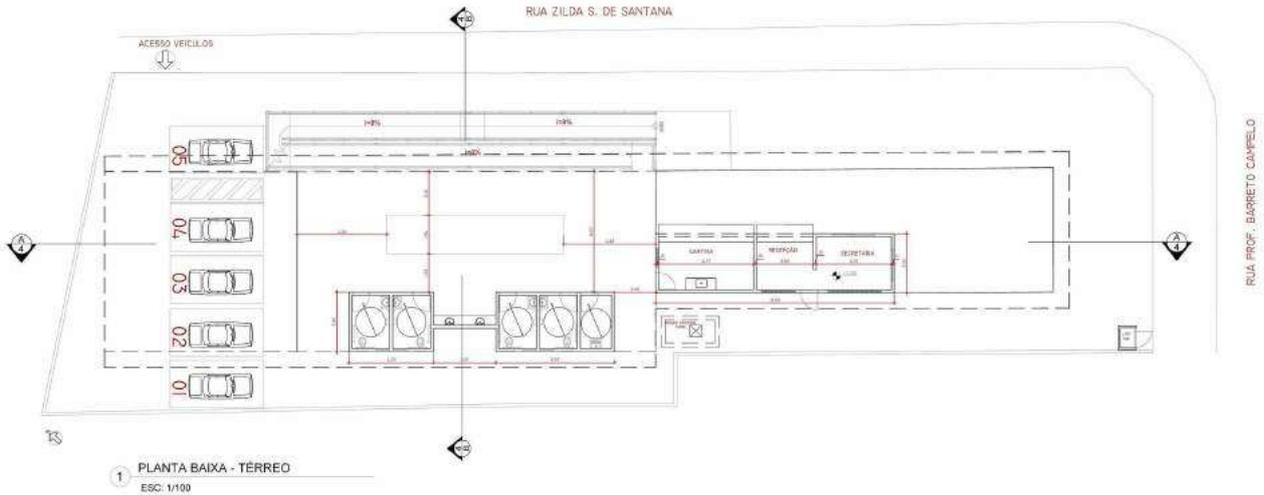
Fábrica de Cultura da Torre - Planta Baixa Térreo
